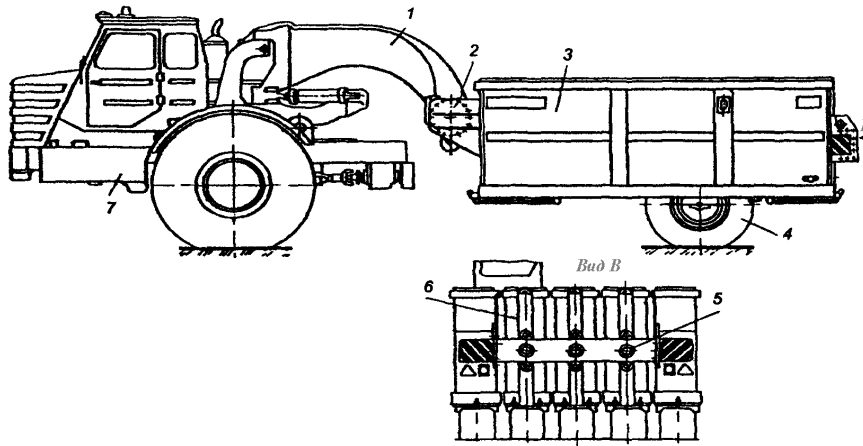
Полуприцепной пневмоколесный каток: 1 – дышло; 2 – рама; 3 – бункер для загрузки балласта; 4 – пневмоколесо; 5 – механизм стопорения секций; 6 – секции катка; 7 – тягач
